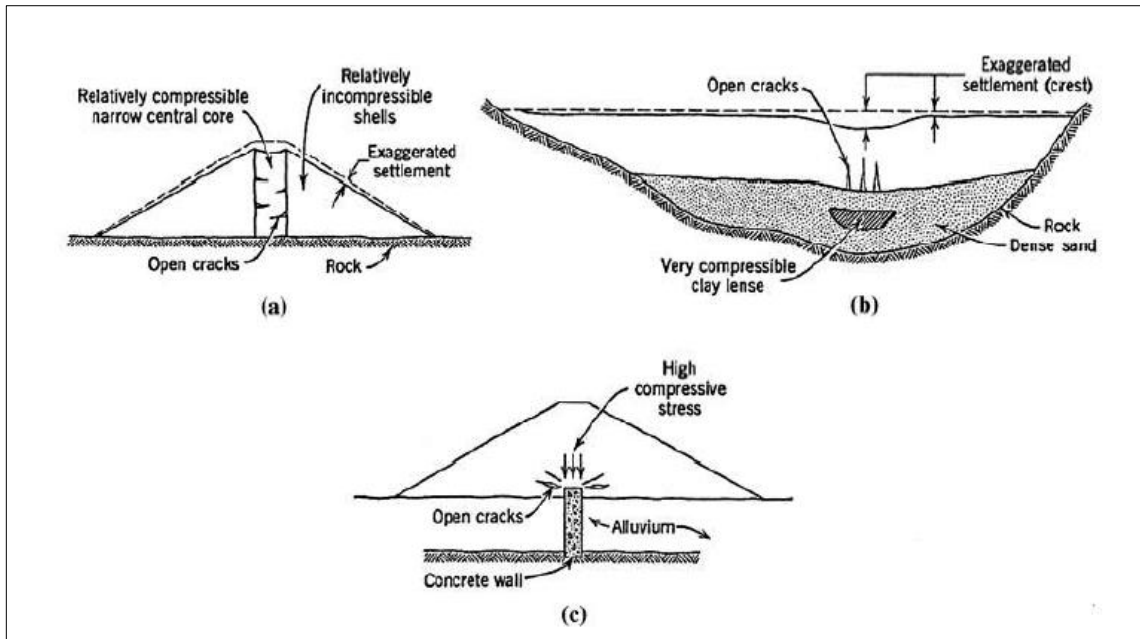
Fisuras internas en una presa de materiales sueltos debido a asientos diferenciales, a) fisuras horizontales en el núcleo, b) fisuras verticales (poco comunes) debido a la presencia de un lentejón, c) fisuras oblicuas (Sherard et al., 1963)
